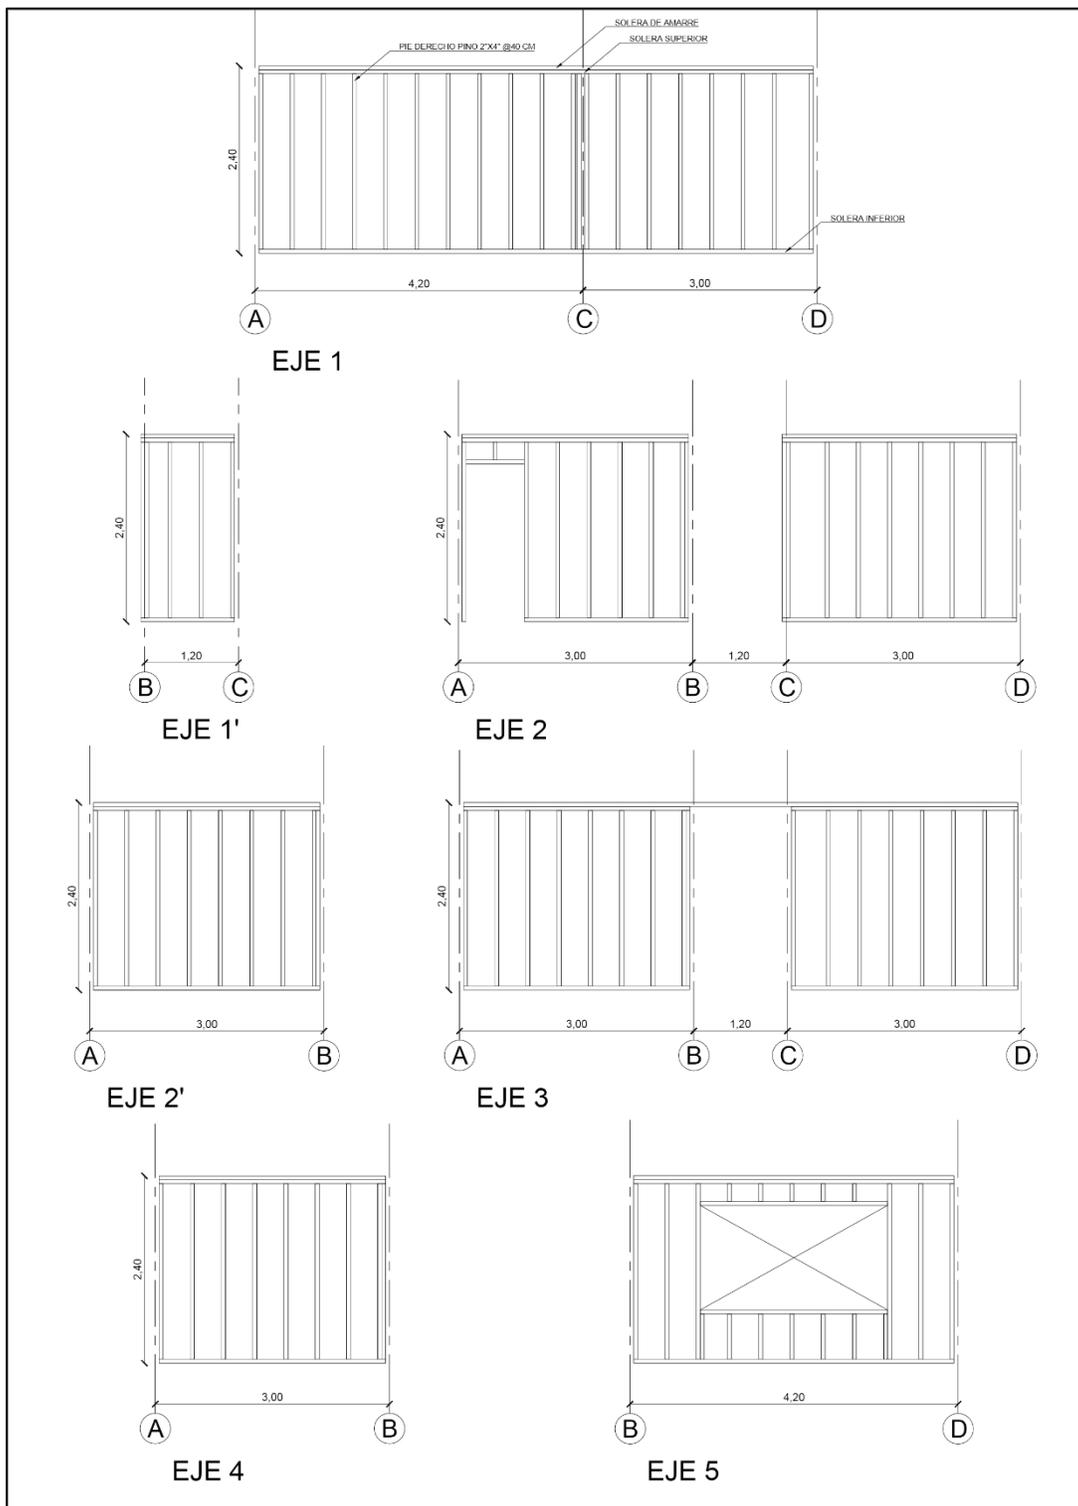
Elevaciones de estructuras modelo entramado de madera 2x4"
